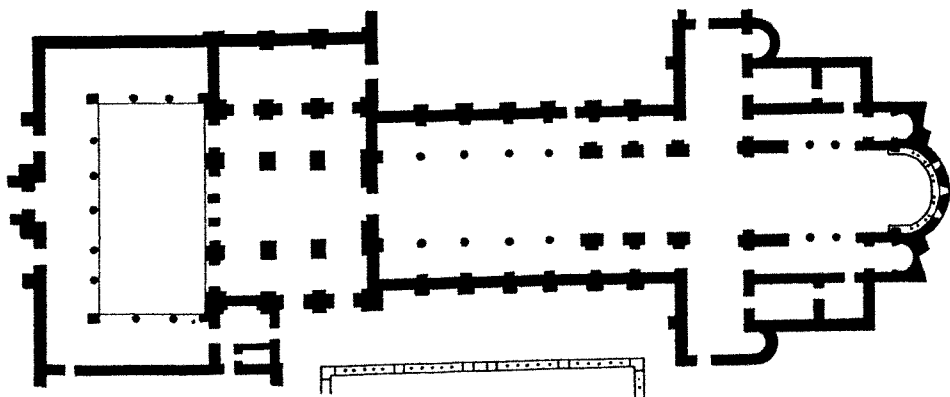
Cluny II, Rekonstruktion des Grundrisses
